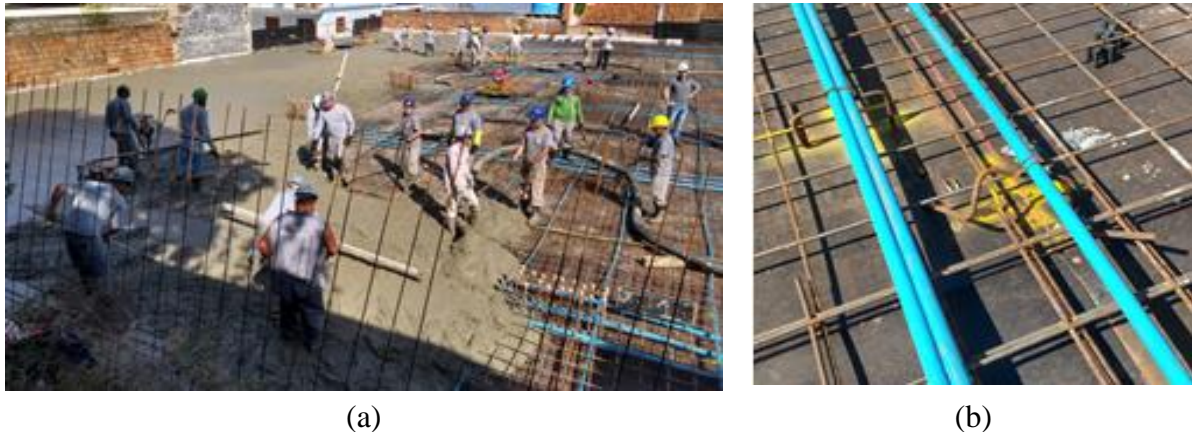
Operação de concretagem: (a) Manuseio da mão de obra em contato com a armadura. (b) Espaçador danificado e mal posicionado.
